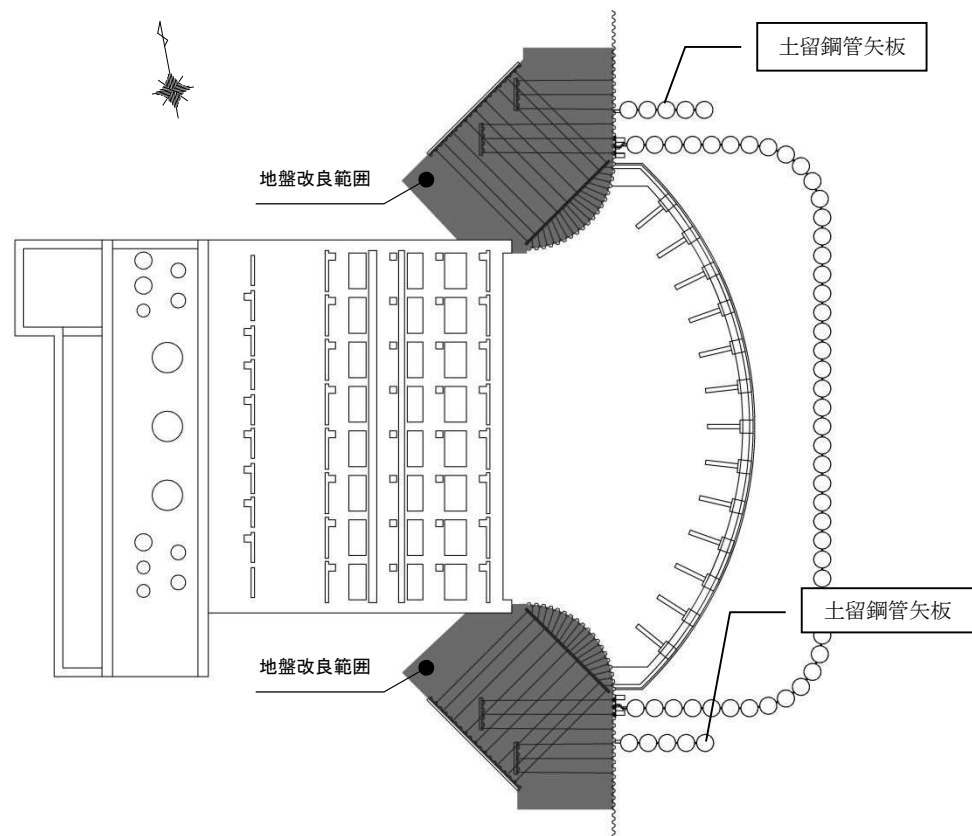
(2) 土留鋼管矢板の平面配置図 (拡大図)
